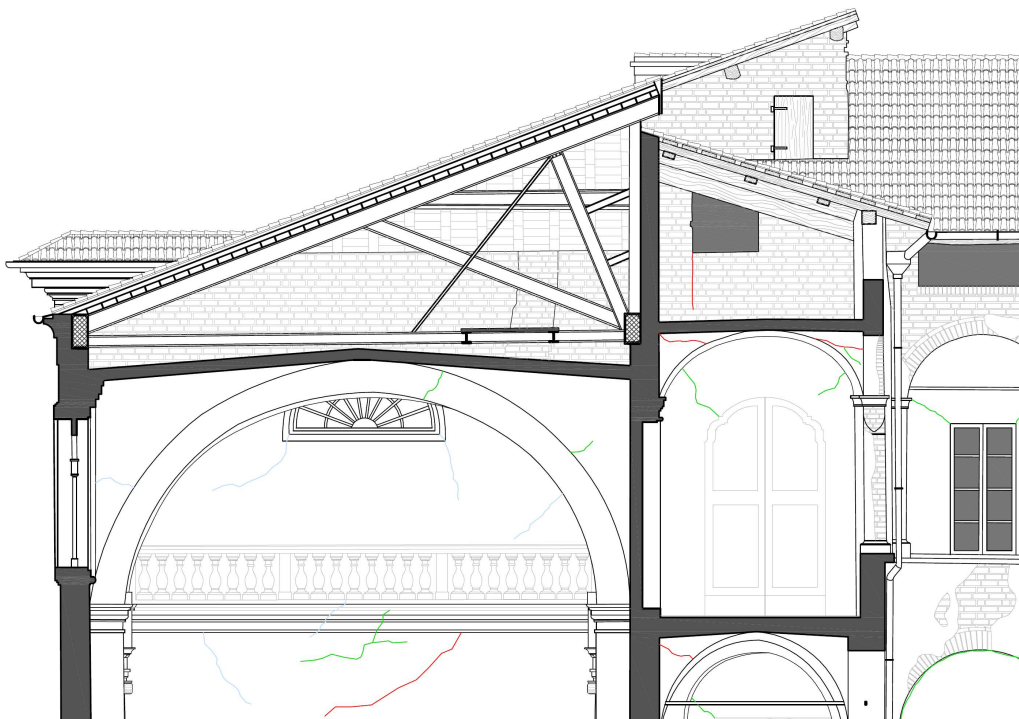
particolare della sezione trasversale D-D. Dal disegno si evince lo schema strutturale della capriata metallica in profilati d'acciaio unita alla cordolatura perimetrale in conglomerato cementizio armato.
